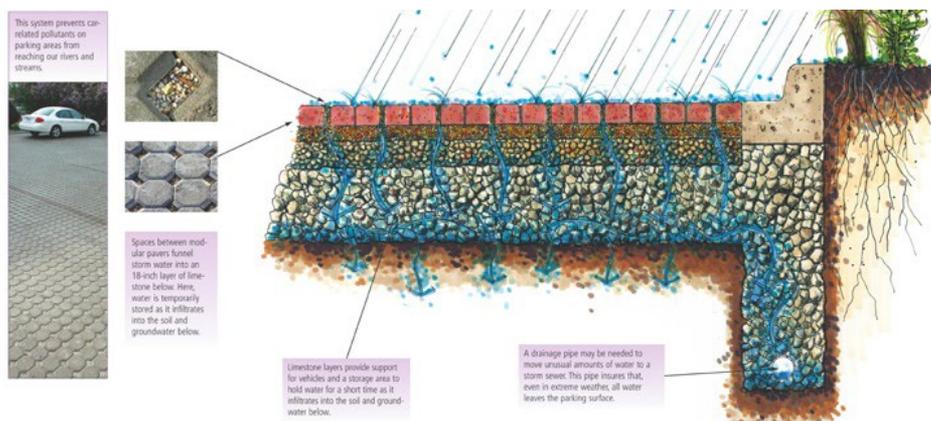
Illustrazione di una pavimentazione permeabile (Source: Doug Adamson, Rdg Planning & Design, provided by USDA-NRCS In Des Moines, IOWA)
